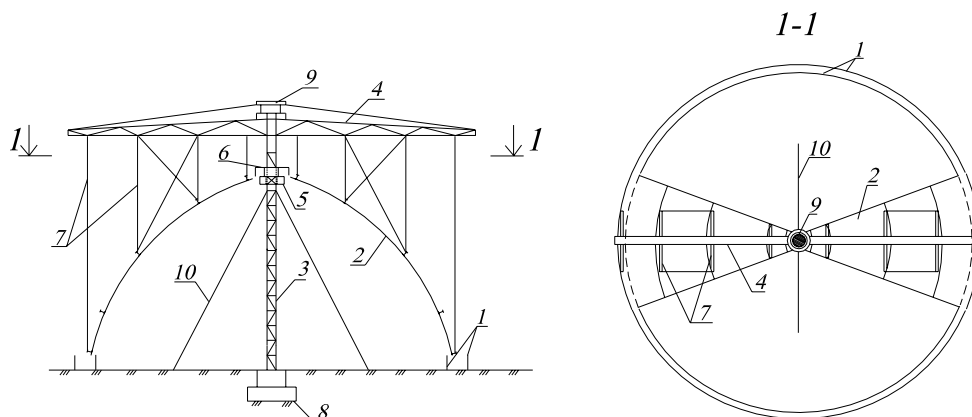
Монтаж опалубки купола: 1 – щиты опалубки нижнего опорного кольца; 2 – опалубка купола; 3 – временная опора; 4 – консольная стрела; 5 – неподвижное кольцо; 6 – опалубка верхнего опорного кольца; 7 – связи; 8 – фундамент временной опоры; 9 – гидродомкрат; 10 – растяжки.
